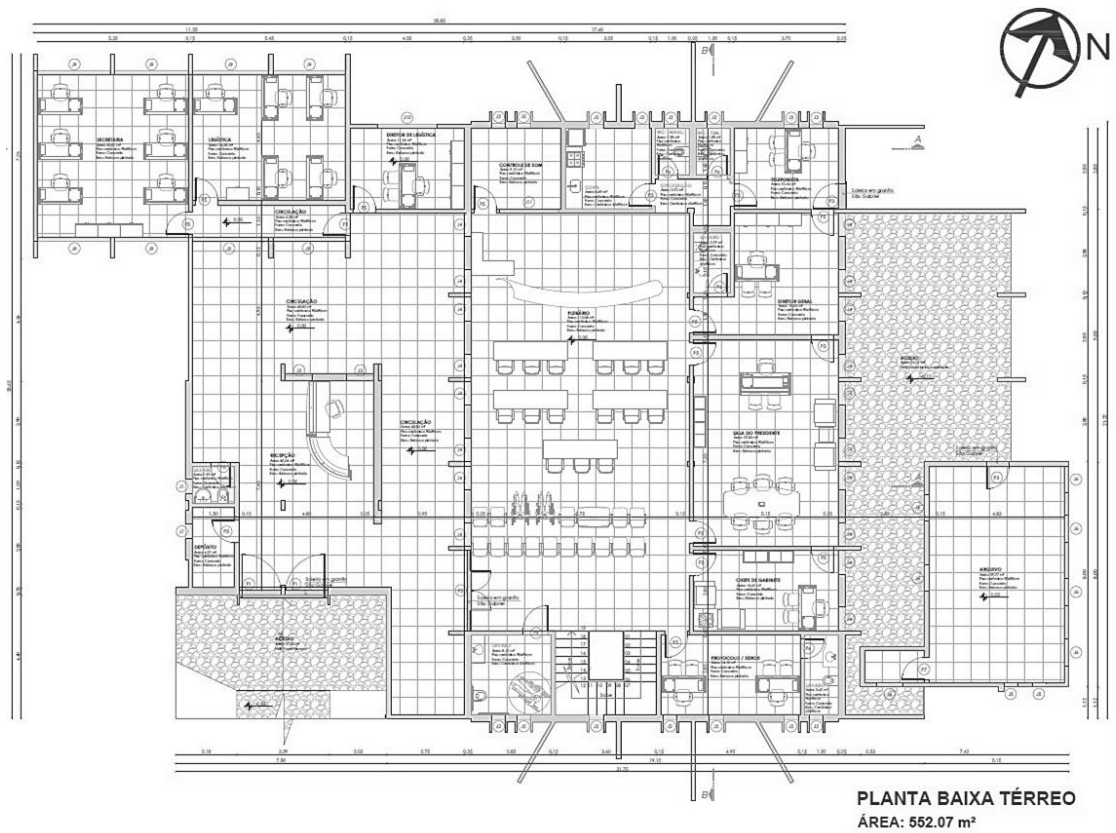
Planta baixa da Câmara de Vereadores. (Fonte: PMC).
